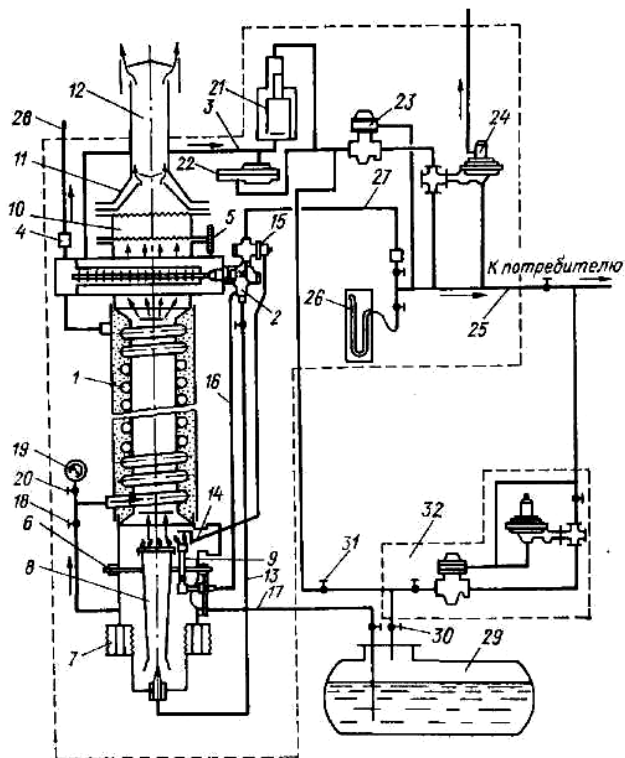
Схема резервуарной установки с испарителем ИГПО-15:
